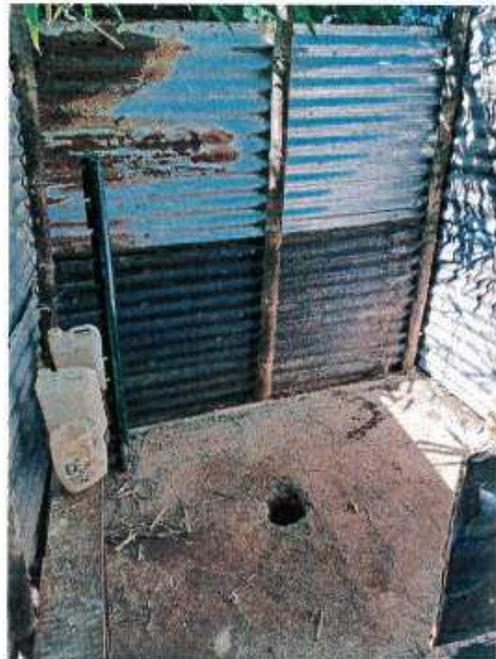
équipement sanitaire rudimentaire, absence d'installation d'assainissement
